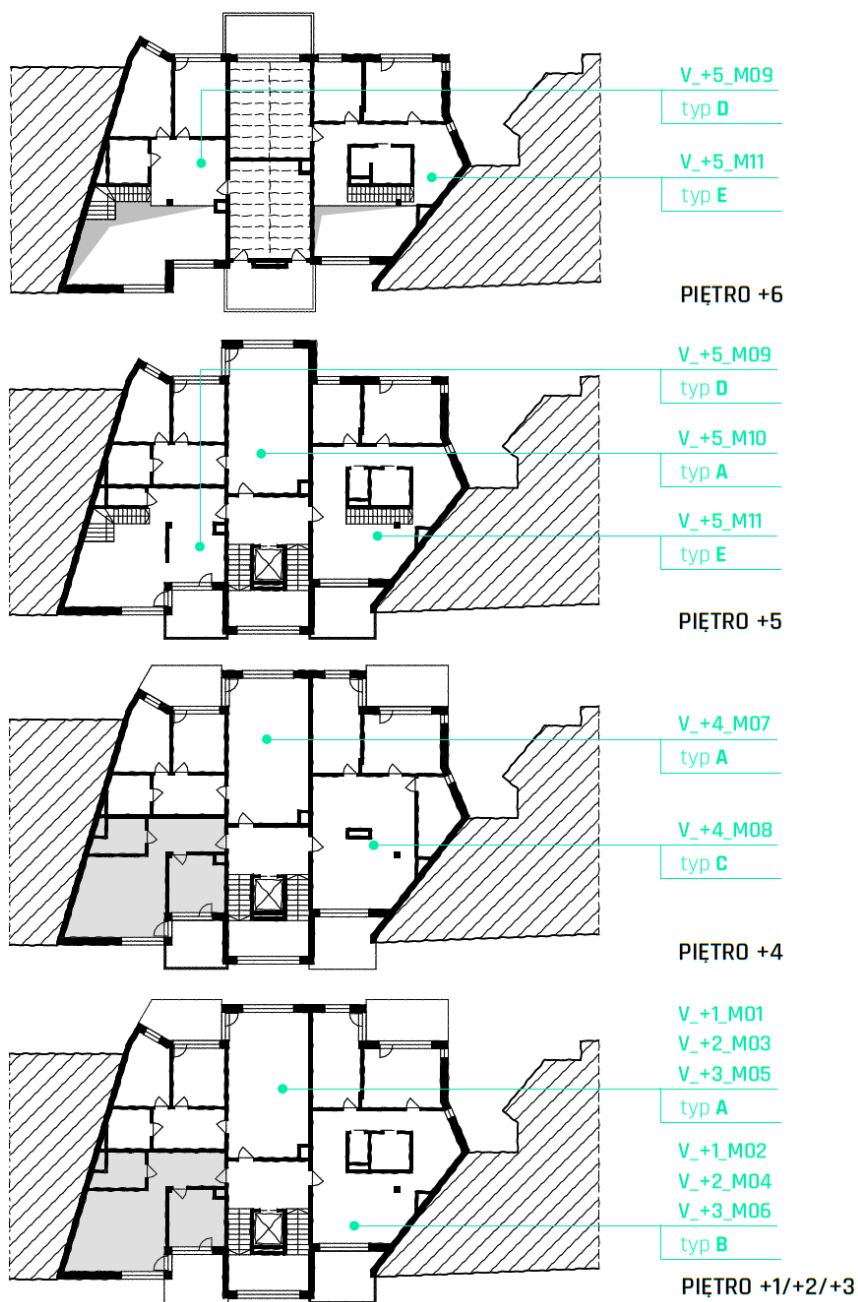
Villa Moderna, plan sytuacyjny, opracowanie autorki
